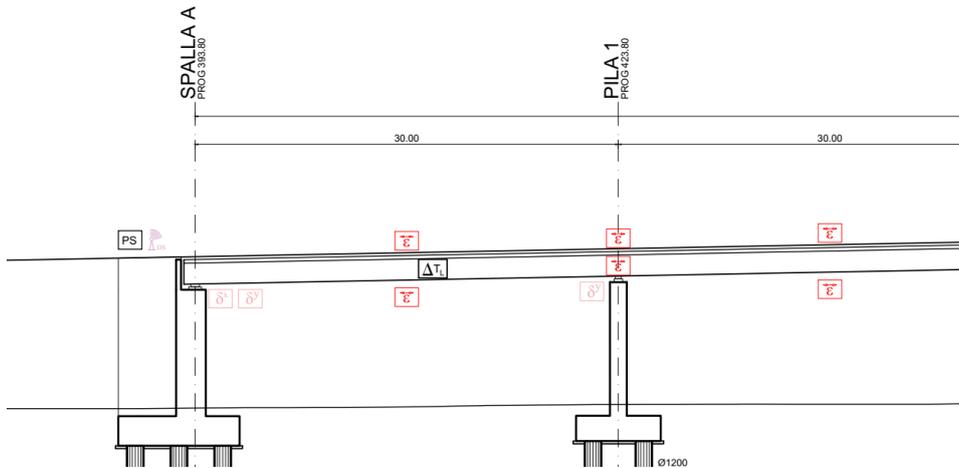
Ubicazione sensori su impalcato (sezione longitudinale prima campata viadotto MdP)
